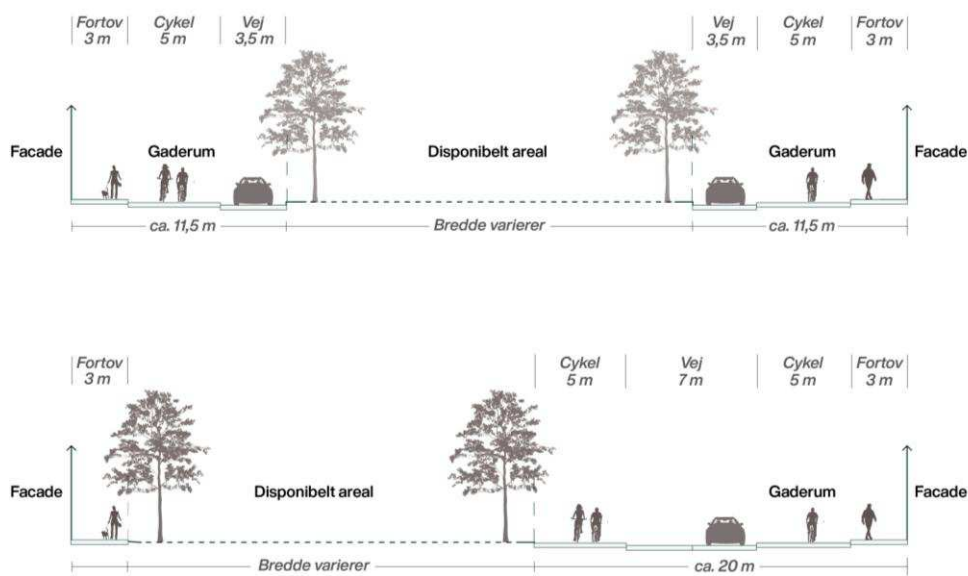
Hovedforslaget mellem Borups Allé og Rysensteensgade
